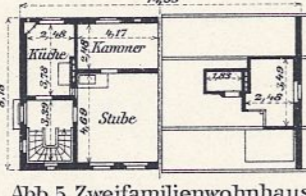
Zweifamilienwohnhaus. Erdgeschoß. Dachgeschoß.
